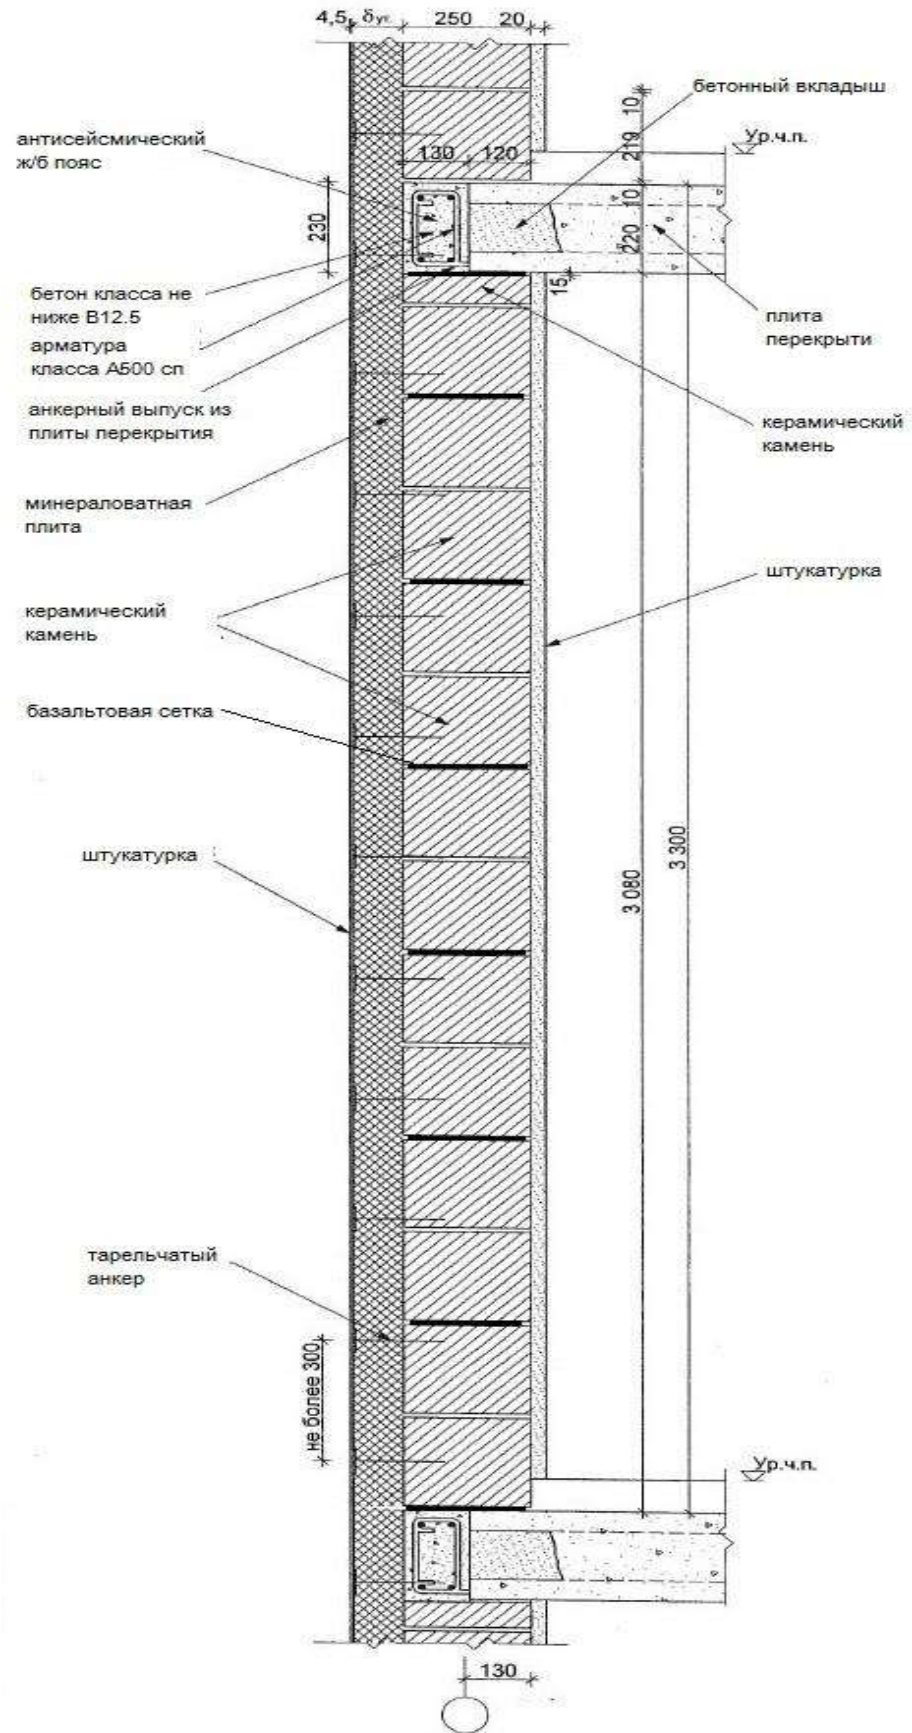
Конструкция двухслойной стены с наружным теплоизоляционным слоем (в том числе для районов с сейсмичностью 7 баллов)
